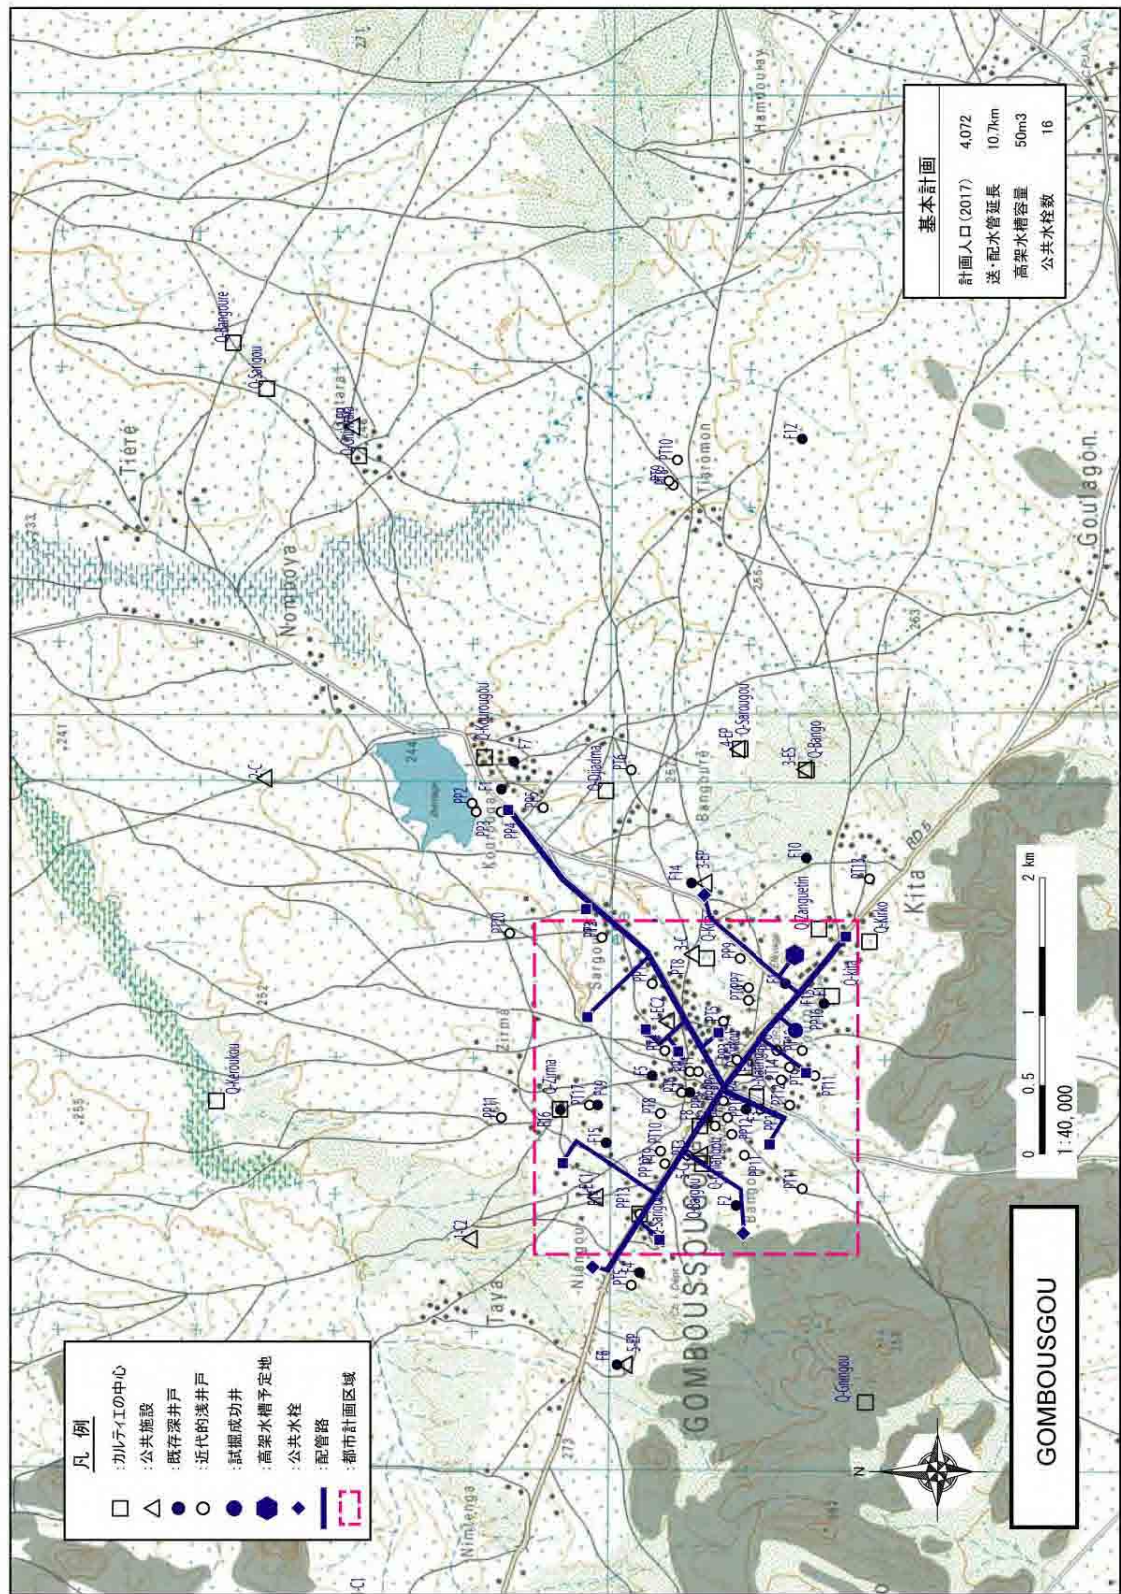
計画対象サイト(Gomboussou)の給水施設広域平面図
